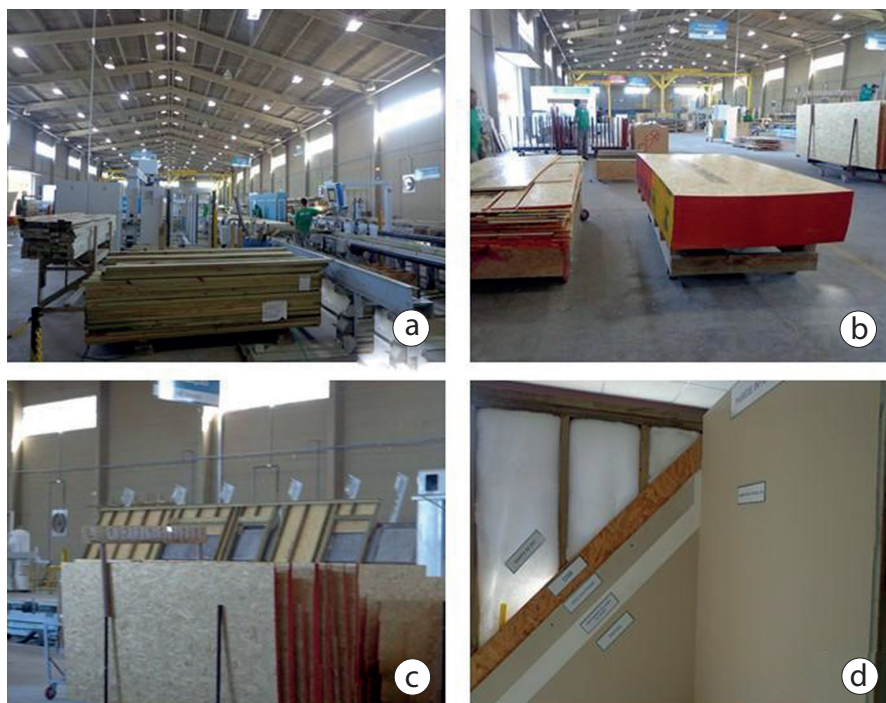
Fabricação dos painéis estruturados em peças leves de madeira (a) Perfis de madeira maciça serrada e tratada; (b) Chapas estrutural para fechamentos; (c) Corte das chapas e fechamento dos painéis; (d) Camadas dos painéis e isolamentos. Fonte: Autores (2016).
